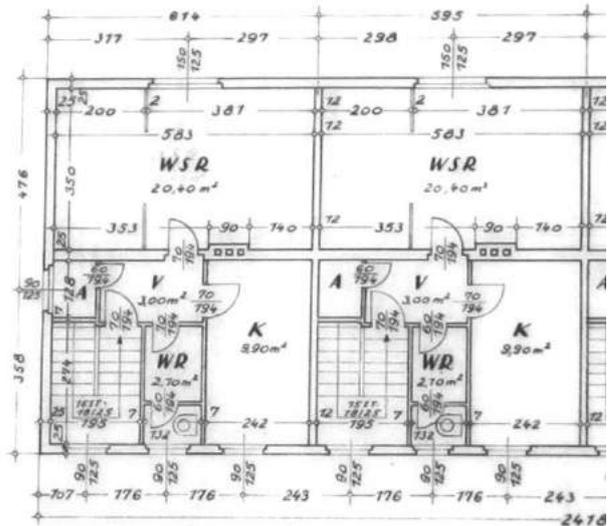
Obergeschoss Wohnungsgrundriss Type III
